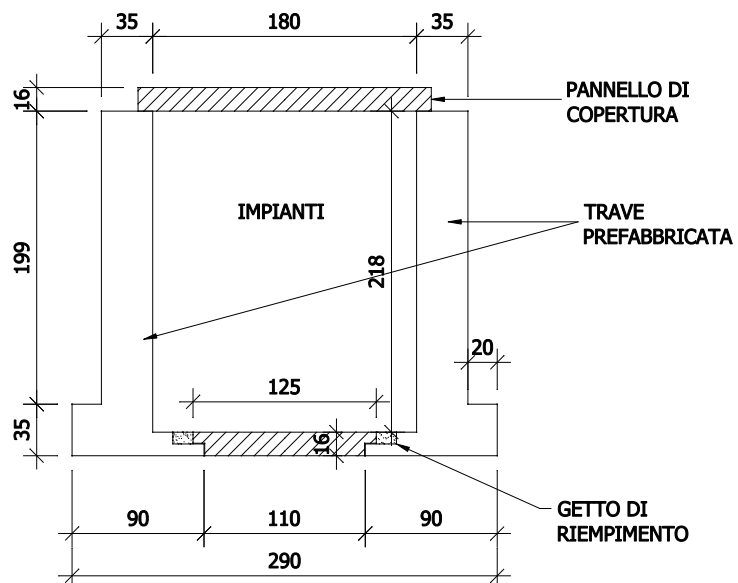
Sezione travi centrali con cunicolo per il passaggio degli impianti.
